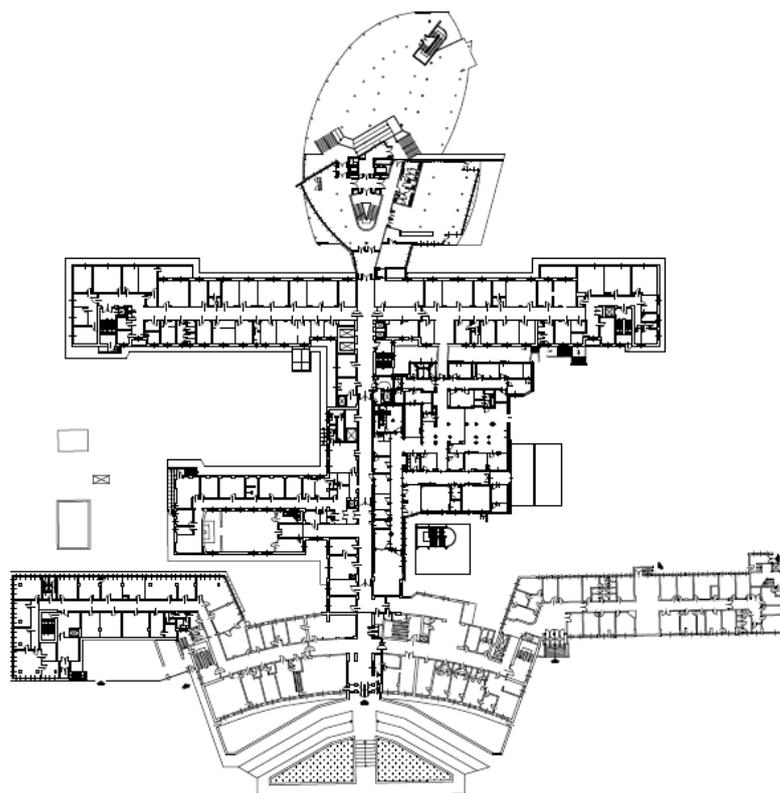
Pianta del primo piano del P.O. Martini
